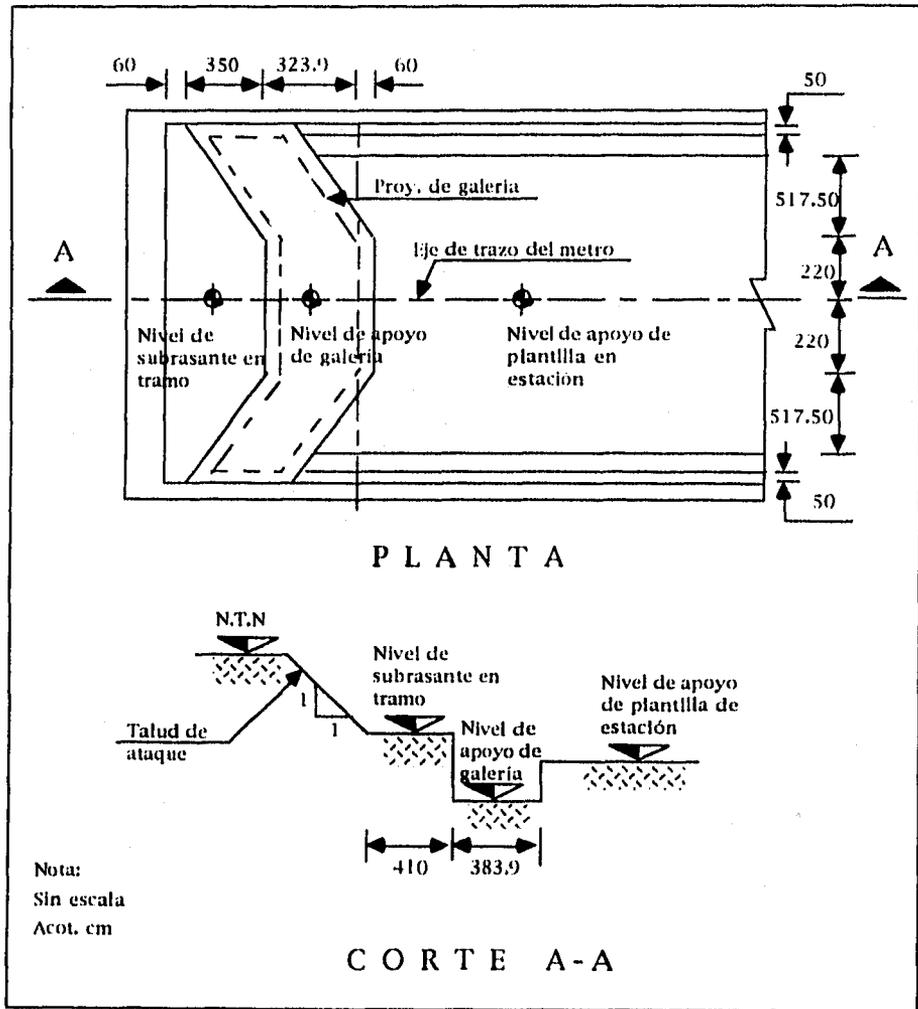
Dimensiones para la excavación de la galería para cables, (planta y corte transversal).
